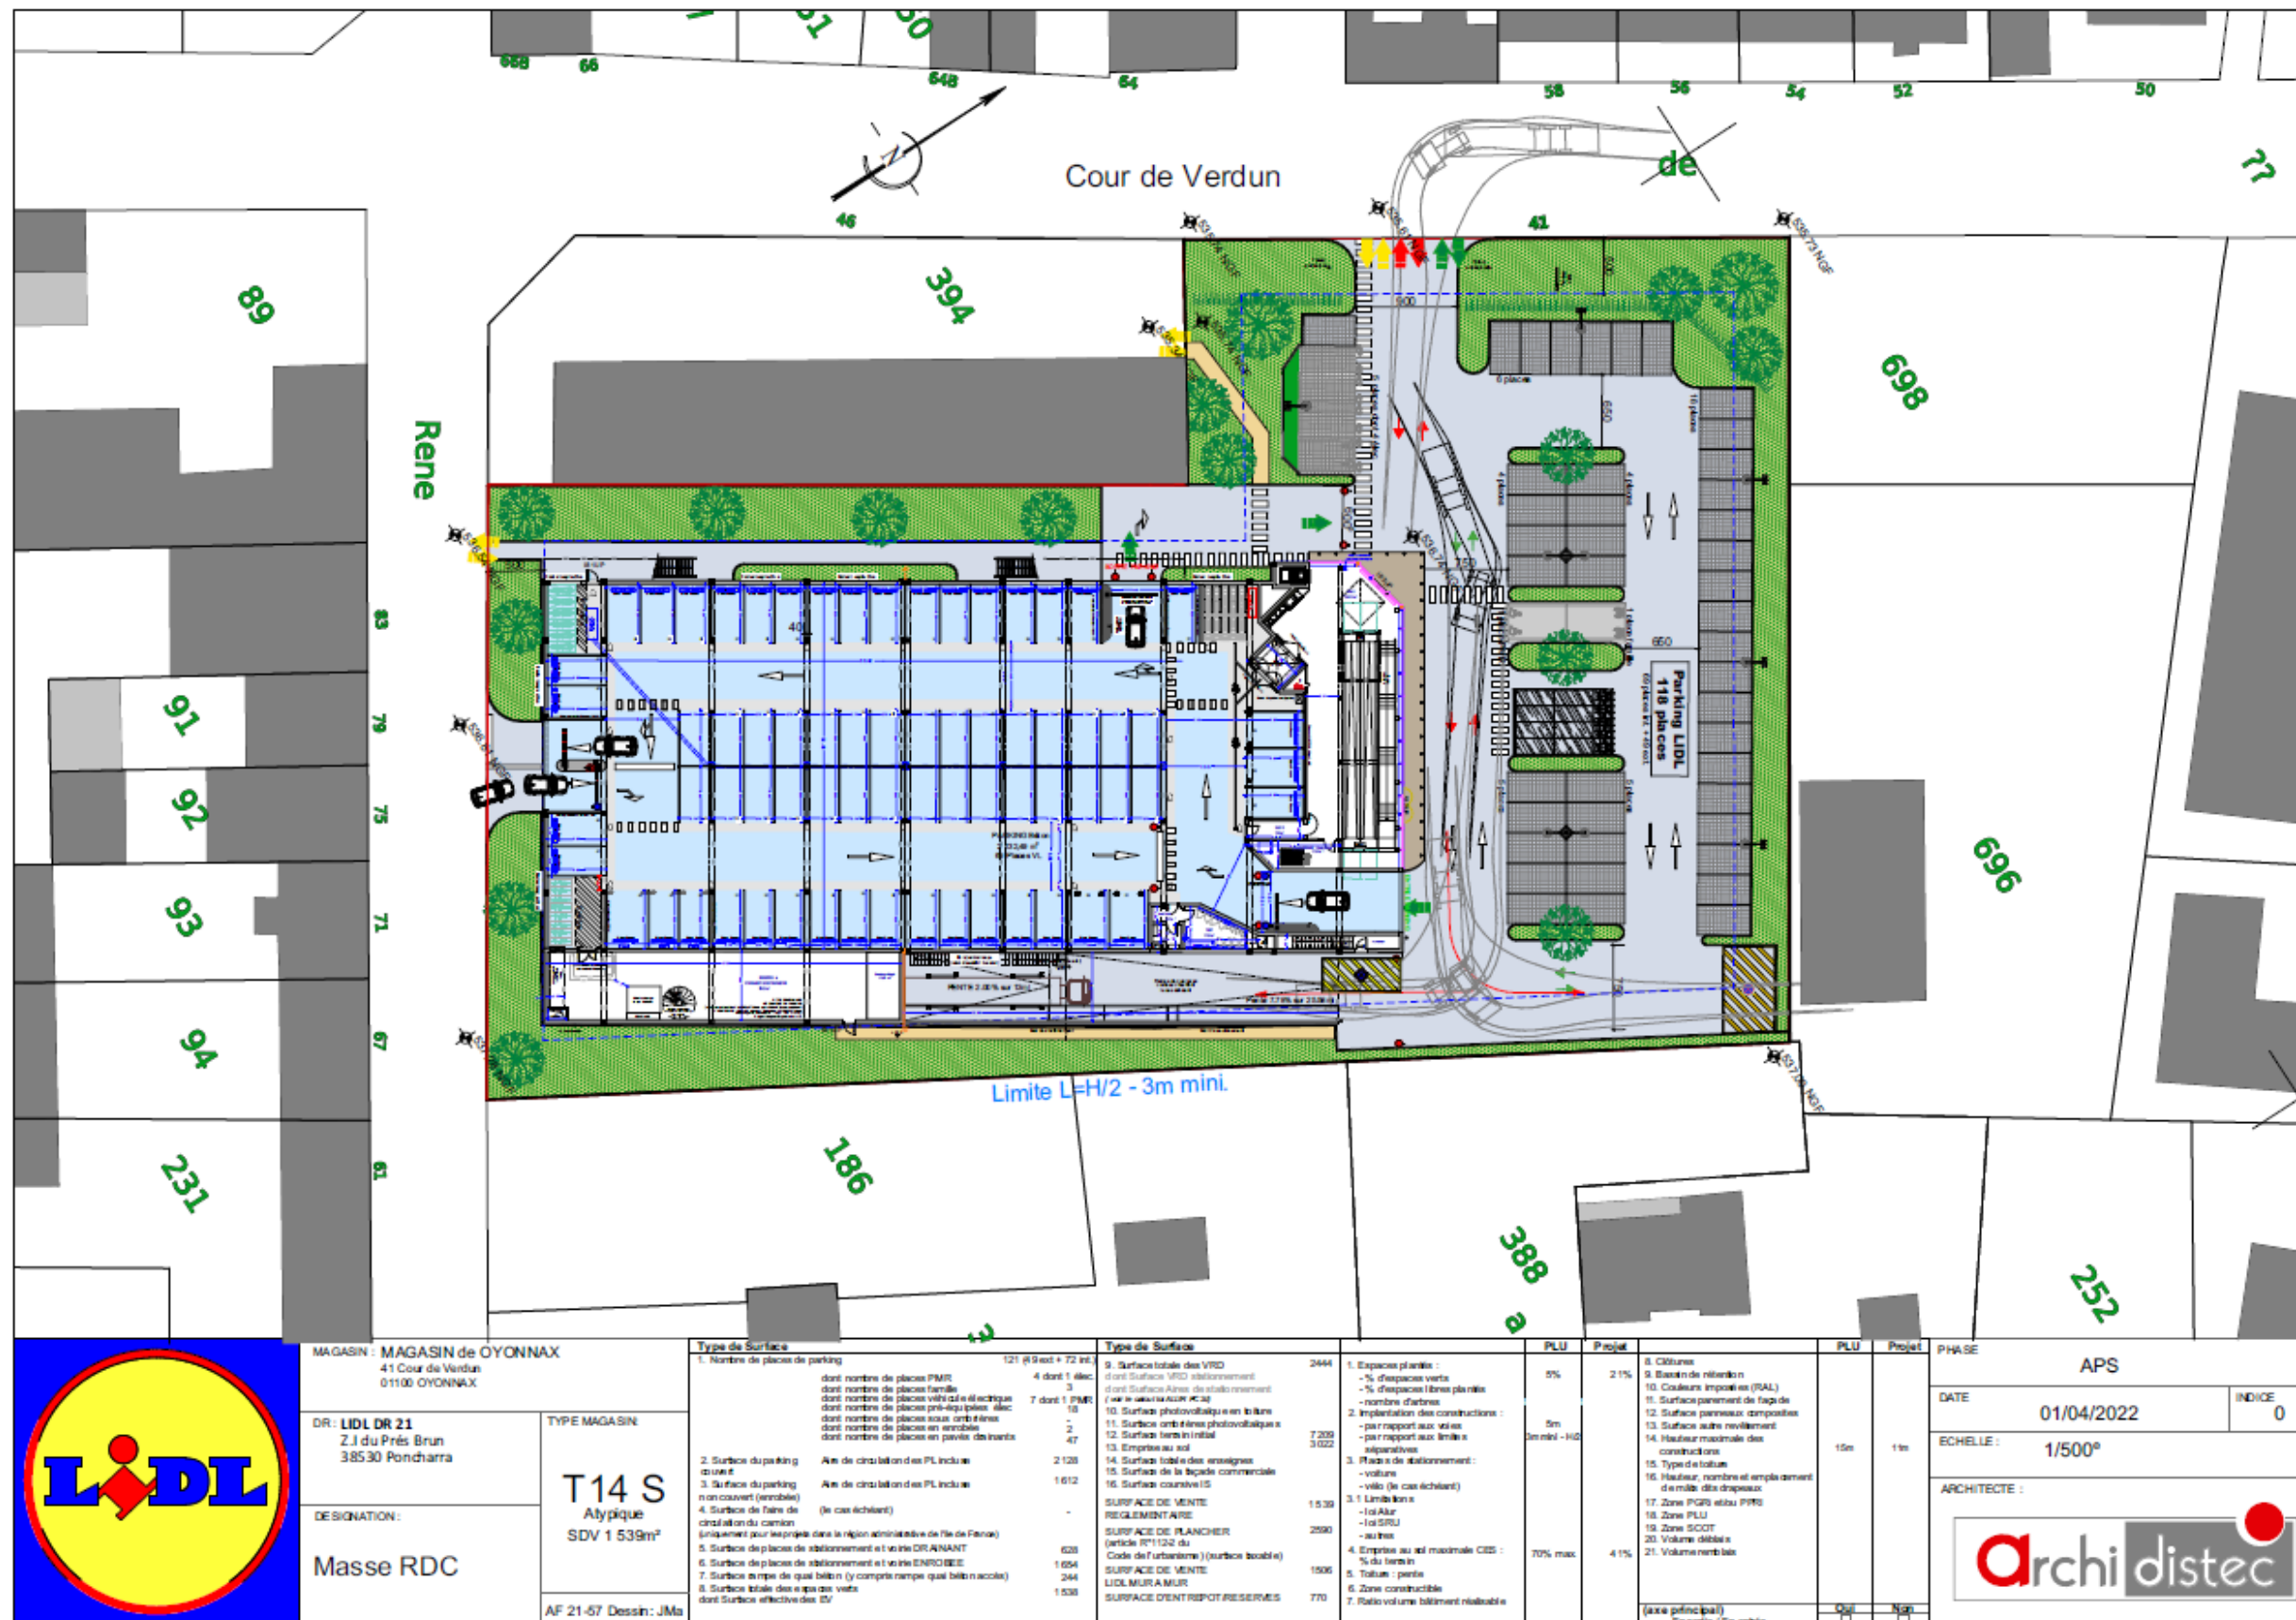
plan de masse projet (source : dossier permis de construire phase APS)
